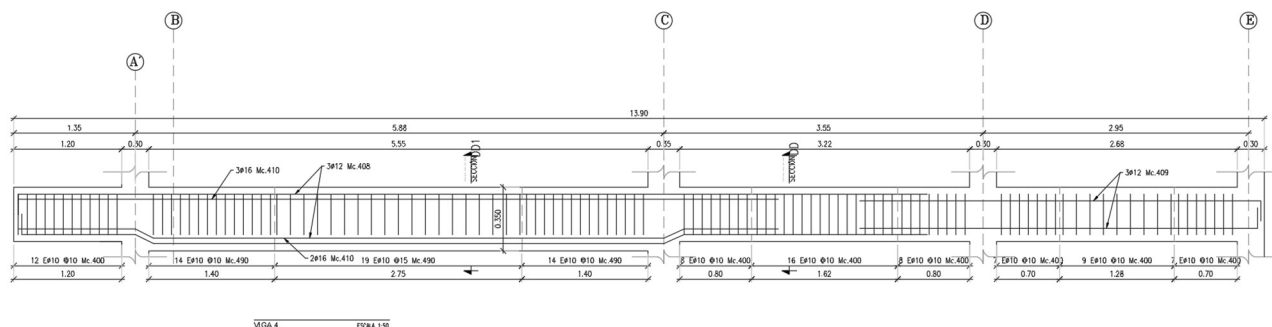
Desarrollo longitudinal de vigas del eje 3
